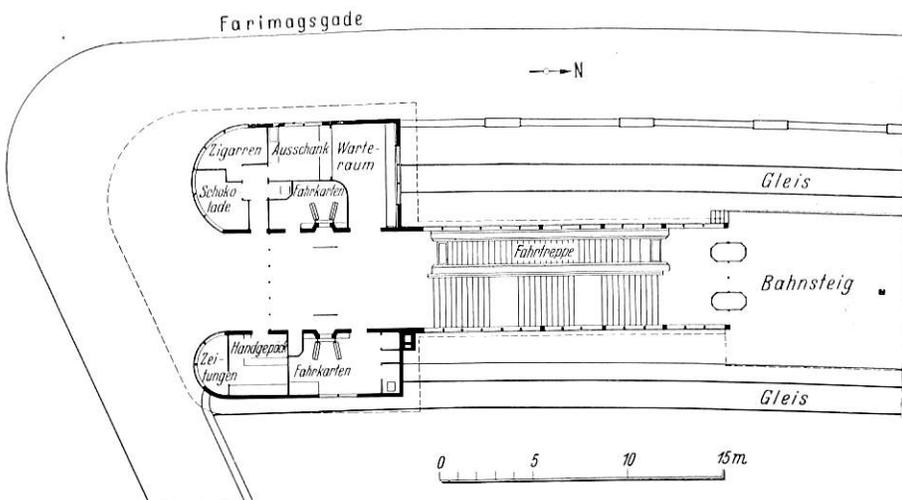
Grundriß des Haltepunktes „Vesterport“ der S-Bahn.
